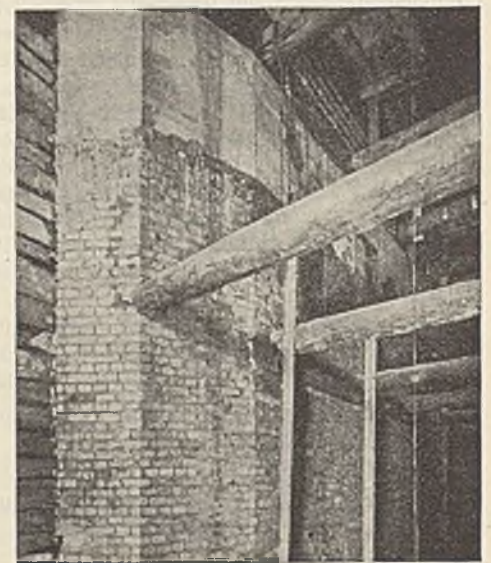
Freigeschachtete, 10 m hohe Unterfangungsmauer des Hauses Cottbusser Damm 103.
